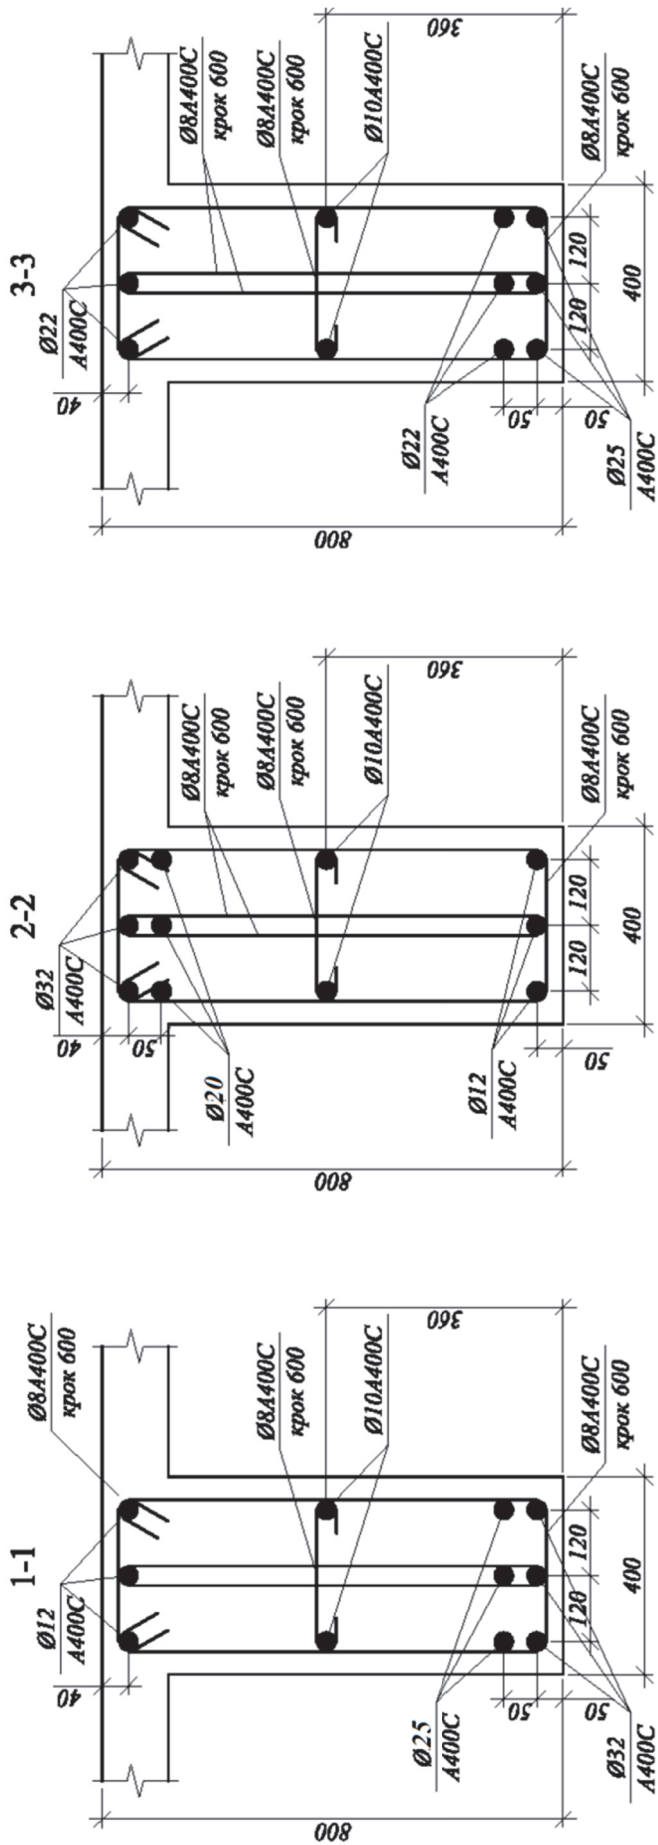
Арматура основних перерізів головної балки окремими стержнями
